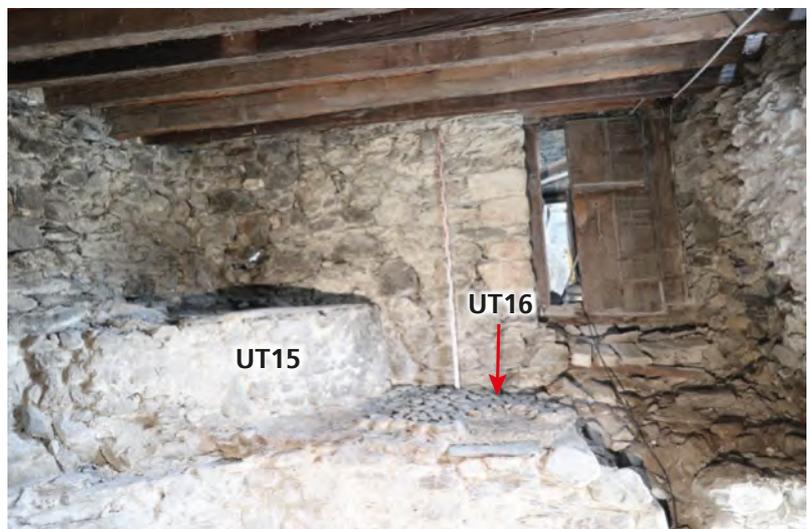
Bâtiment 1, local L. 6. Le foyer (UT15) est associé à un sol en pierres (UT16) installé sur une bande de 1,50 m le long de la paroi sud. Sur le reste de la surface, le sol consistait en un plancher (disparu). Vue du nord.
